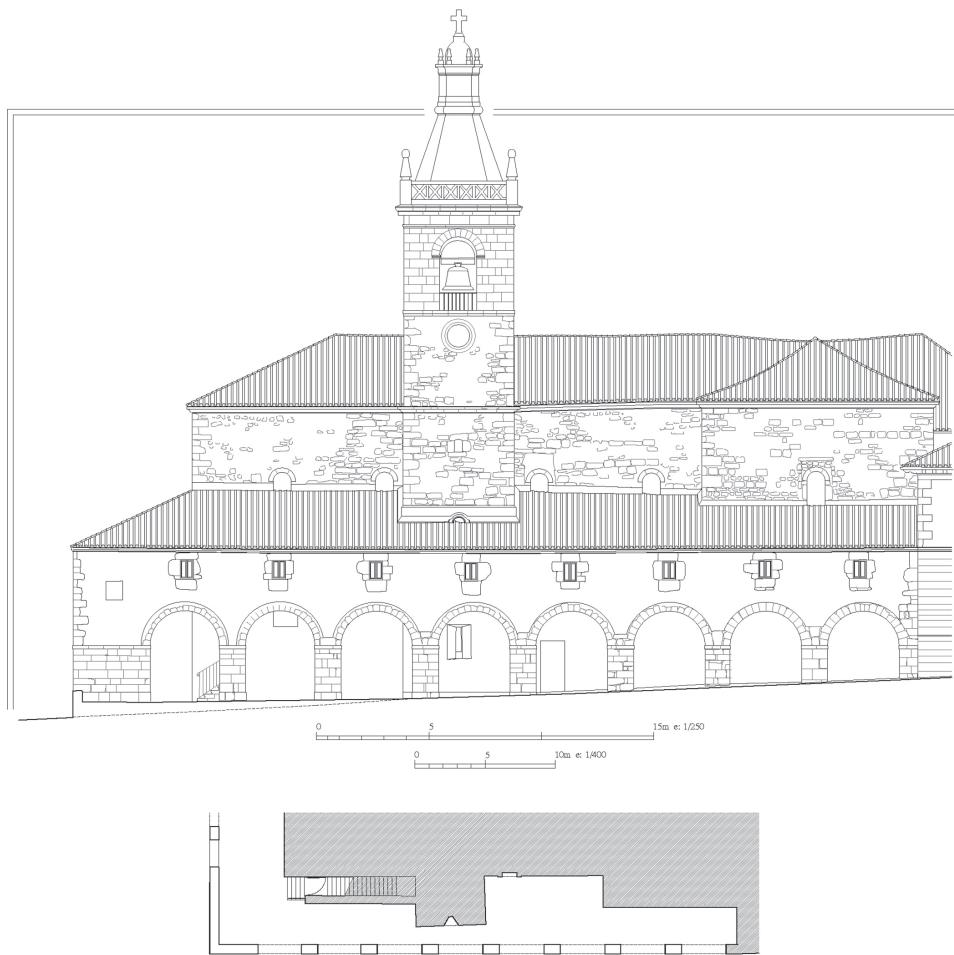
Planta y alzados de la casa Serorategia (Arizkun). / Elevation and plan of the house Serorategia (Arizkun).
